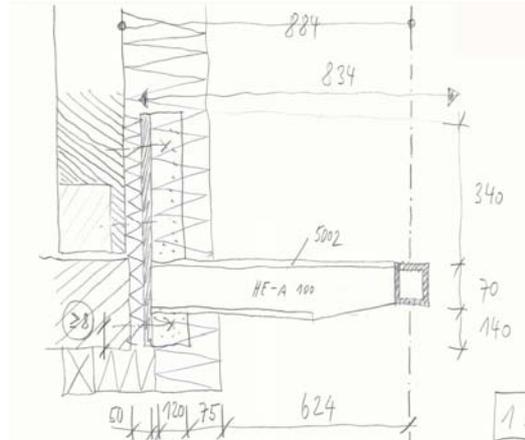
Detailskizze Befestigungspunkt der Fassade
